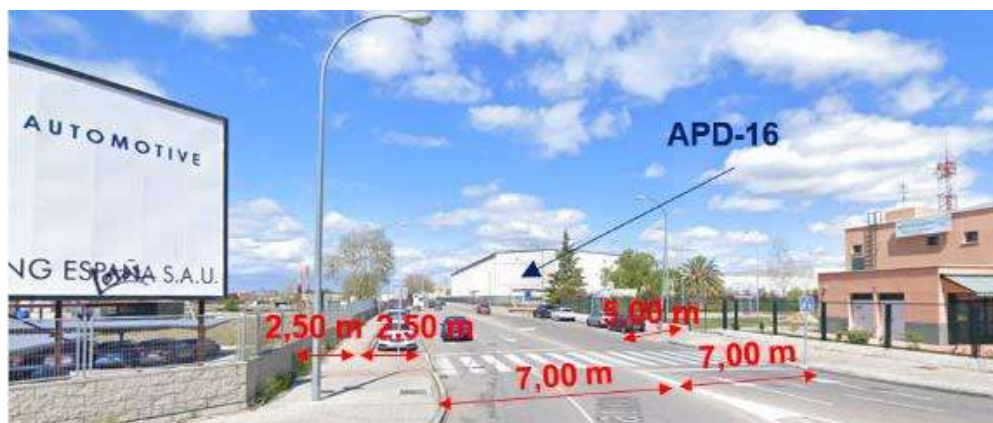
Sección de la calle Sauce desde la glorieta con Av. de la Encina hasta los primeros metros del APD-16
